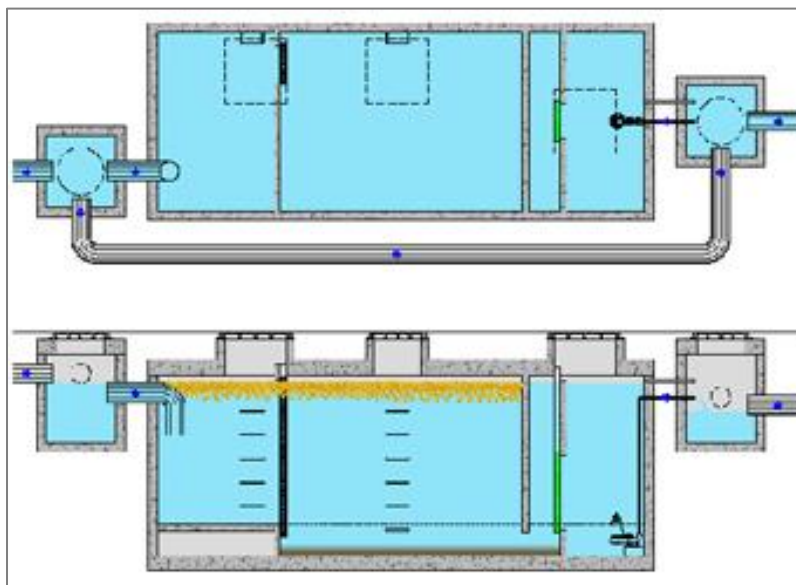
Esquema de la planta de tratamiento de lluvia
